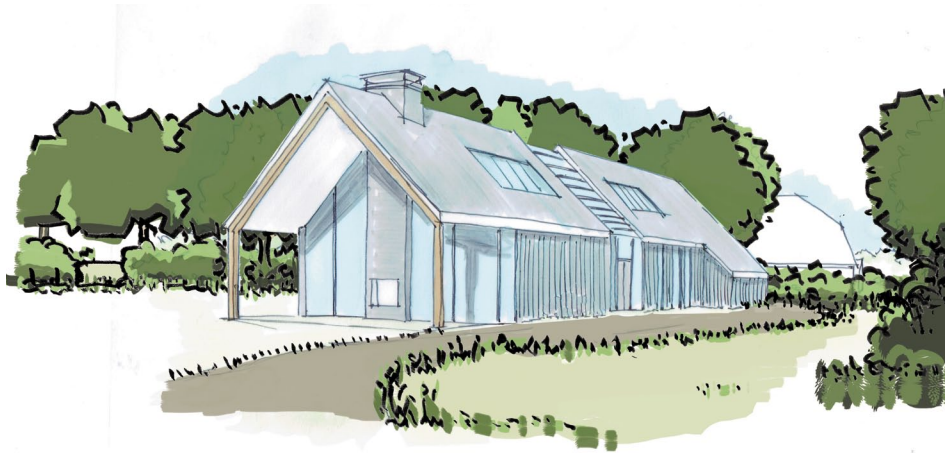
Schetsimpressie voorgevel (noordwest) houtwalwoning met geïntegreerd bijgebouw en opdeling kap
